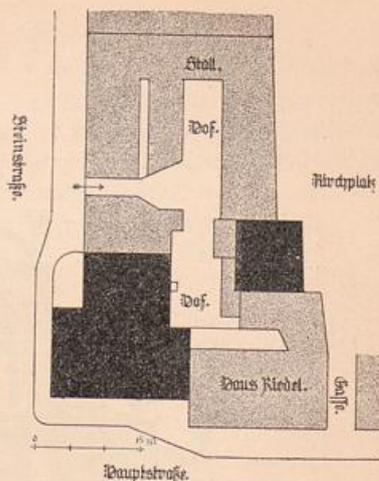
Lageplan des ehemals Storbek'schen Hauses.
